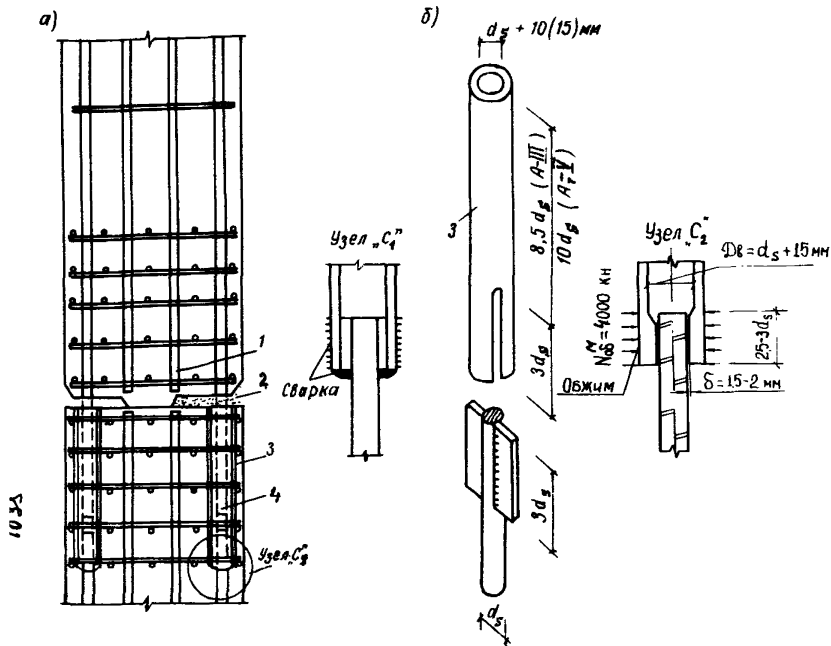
Армирование контактного стыка типа IV (с обрывом части продольной арматуры и выпуском угловых стержней с их анкерровкой в соответствующих гнездах)
